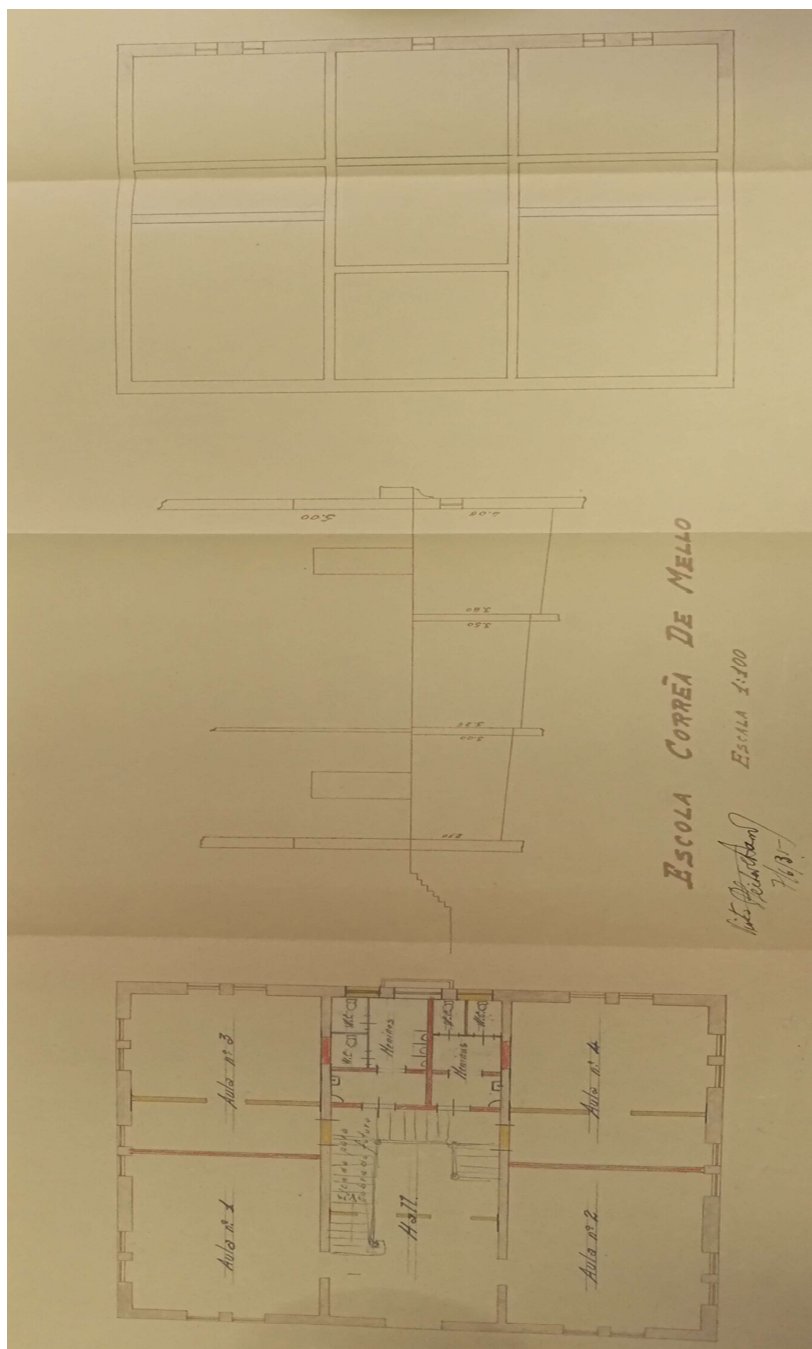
Planta de 1935 da Escola Corrêa de Mello, apresentando o pavimento térreo, o corte e o porão. Requerimento nº: 1027 de 17 de maio de 1935. Arquivo Municipal de Campinas.
